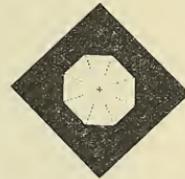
Grundriss des Turmes am Friedhofe von Szigliget.
